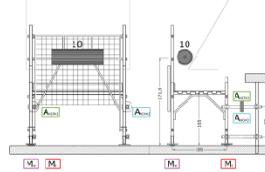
1 Prove d’impatto con rullo cilindrico su protezione continua – Schema CSR – Posizione degli strumenti di misura
